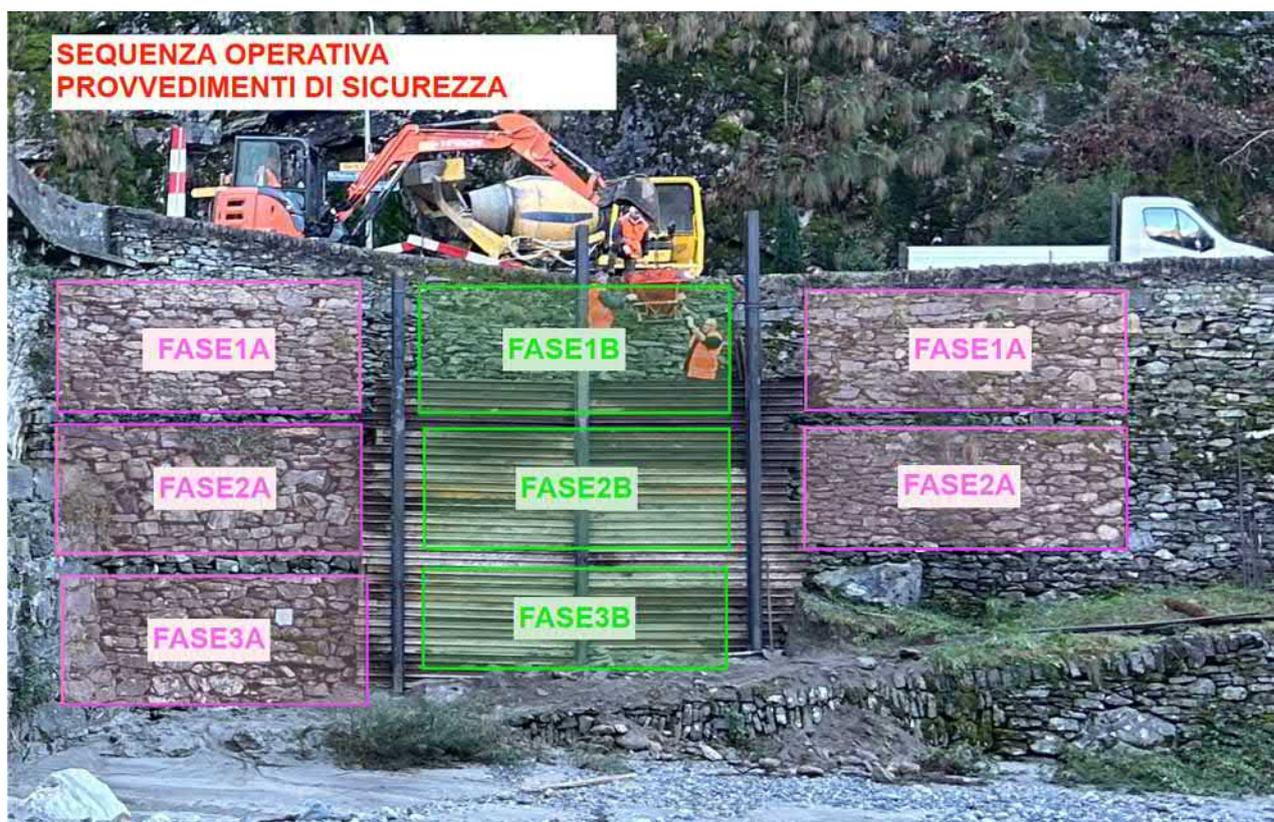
Fasi di esecuzione del consolidamento e ricostruzione del muro
